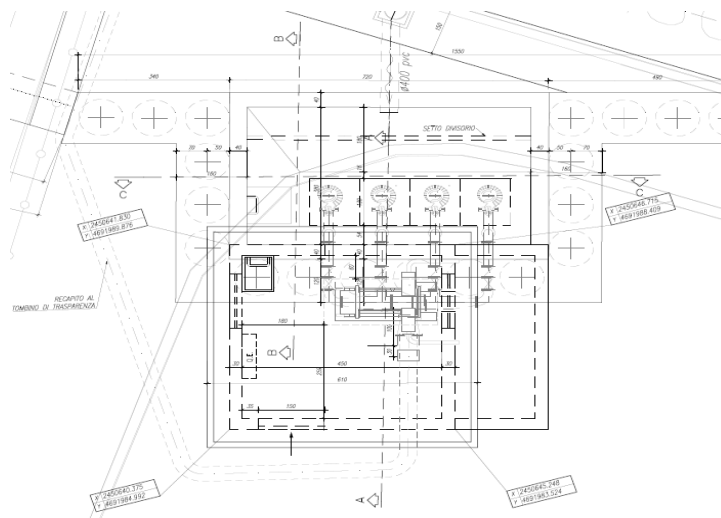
Impianto di sollevamento NV16 – Pianta
